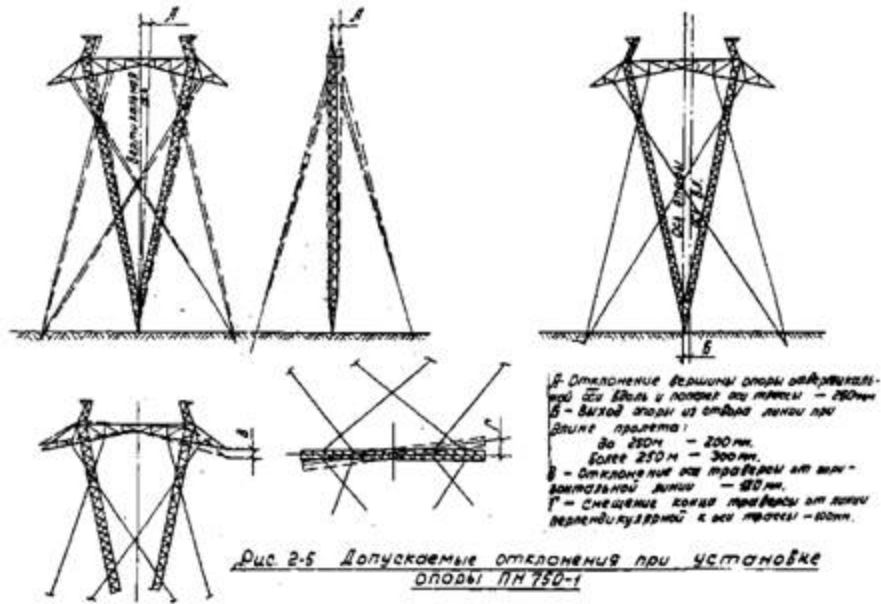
допускаемые отклонения при установке опоры ПН 750-1
